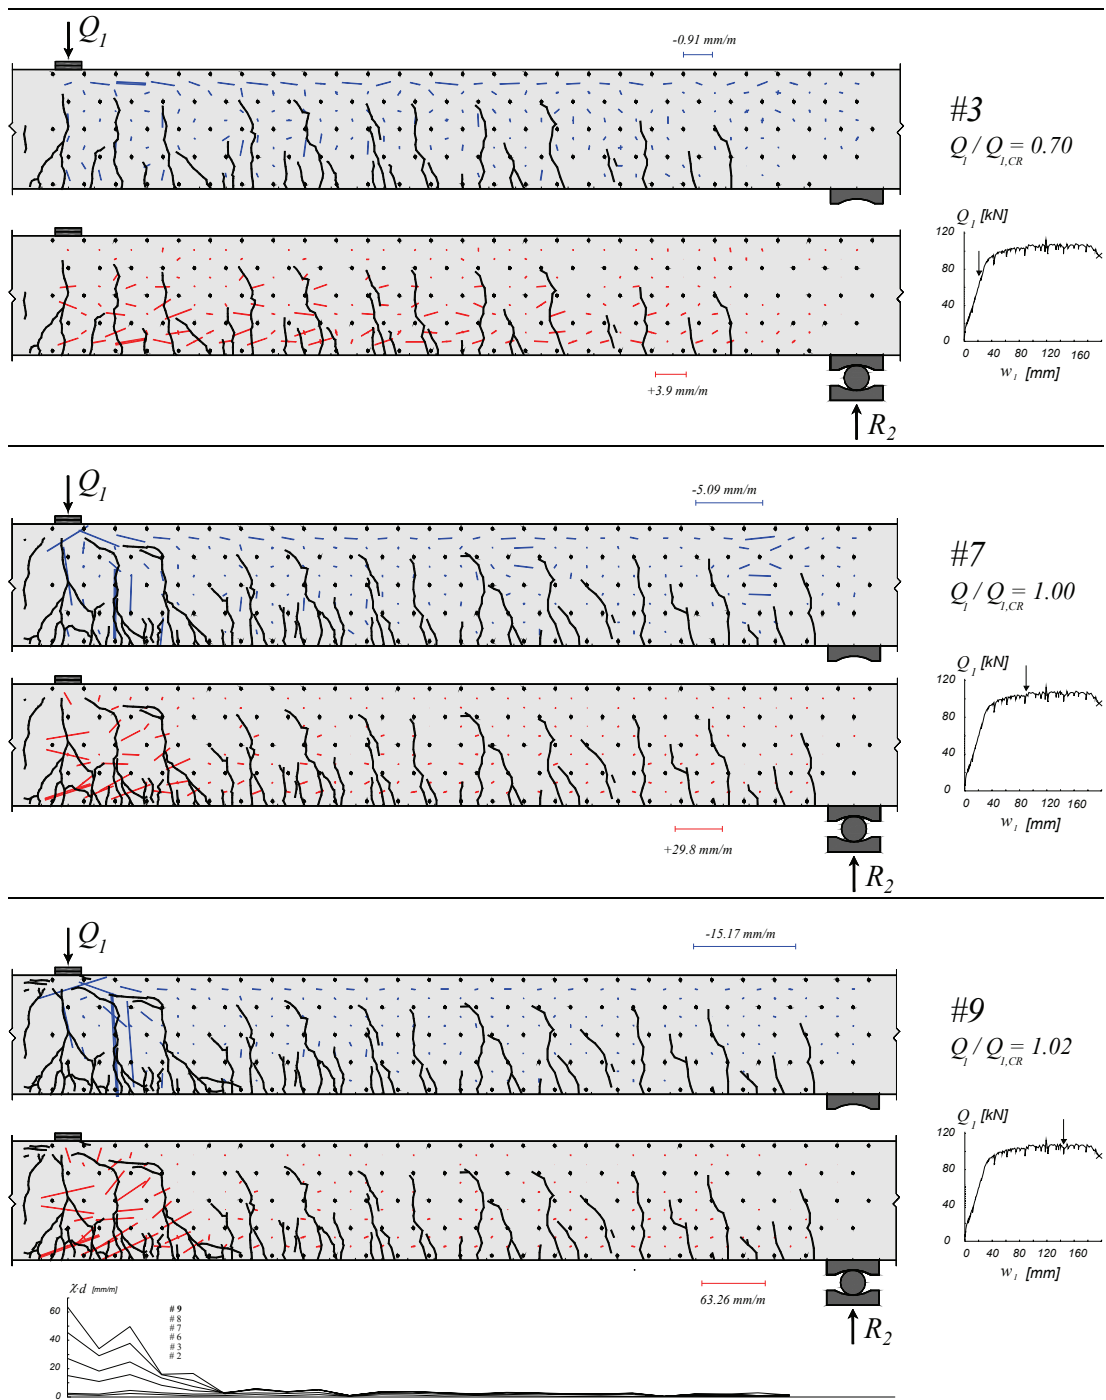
Poutre SR5: déformations principales, fissuration et courbures
